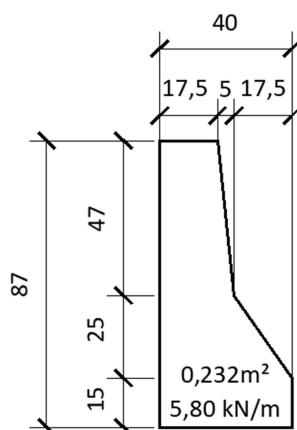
1: Barreira tipo *New Jersey* em concreto armado, unidades em cm.
